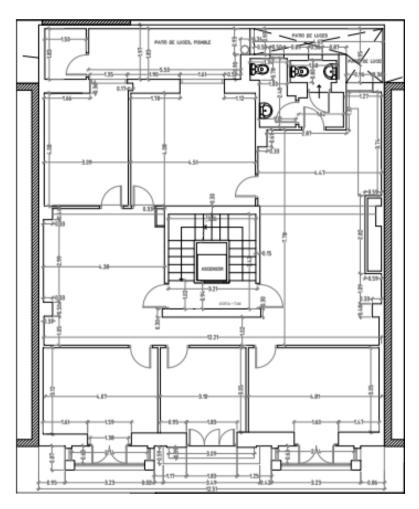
Estado actual Planta 2. Fuente: Creación propia
